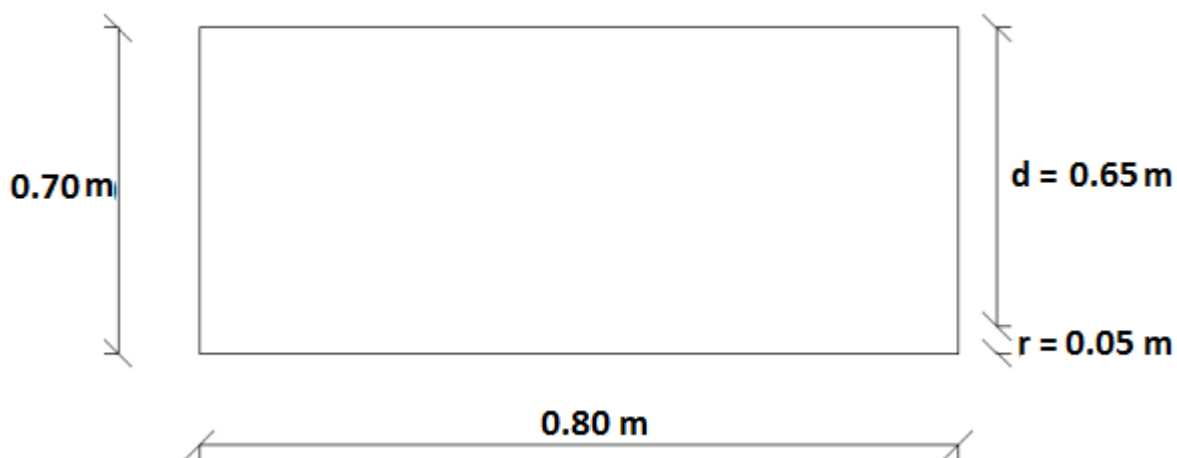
Viga de asentamiento de la superestructura. Elaborado por: Autor
